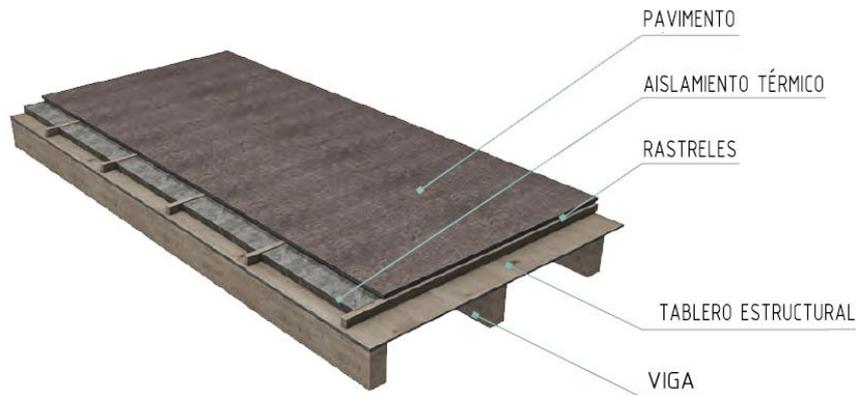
Entramados pesados: detalle elementos forjado de madera
